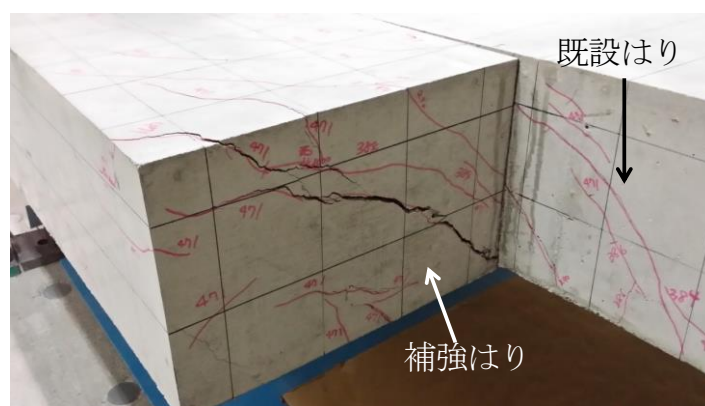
補強はり端部ひび割れ性状 (No.14)
